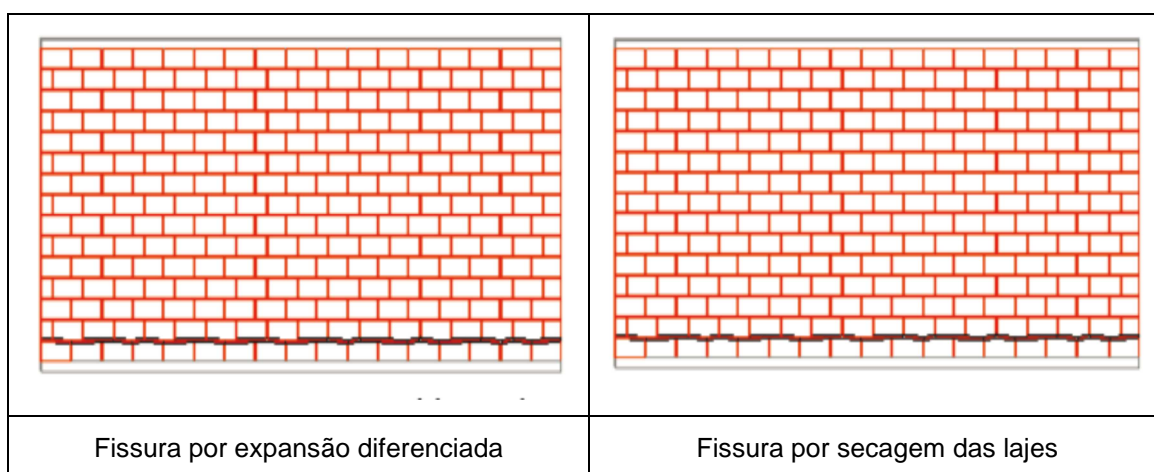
Fissuras por expansão diferenciadas e por retração de secagem das lajes.
